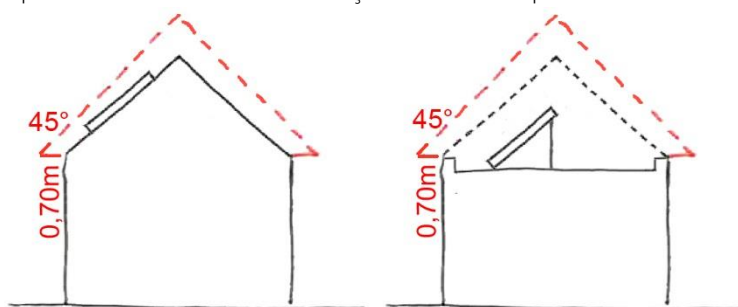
Panneaux solaires et photovoltaïques en toiture en pente et en toiture plate
